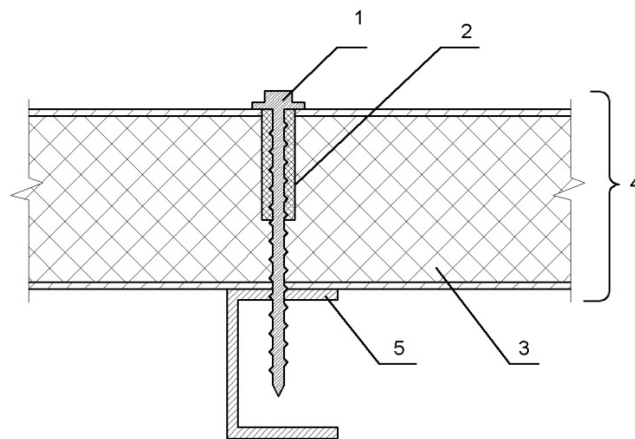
Вариант утепления места крепления сэндвич-панели к каркасу здания: 1 – самонарезающий винт; 2 – теплоизоляционная втулка; 3 – сэндвич-панель; 5 – элемент каркаса здания
